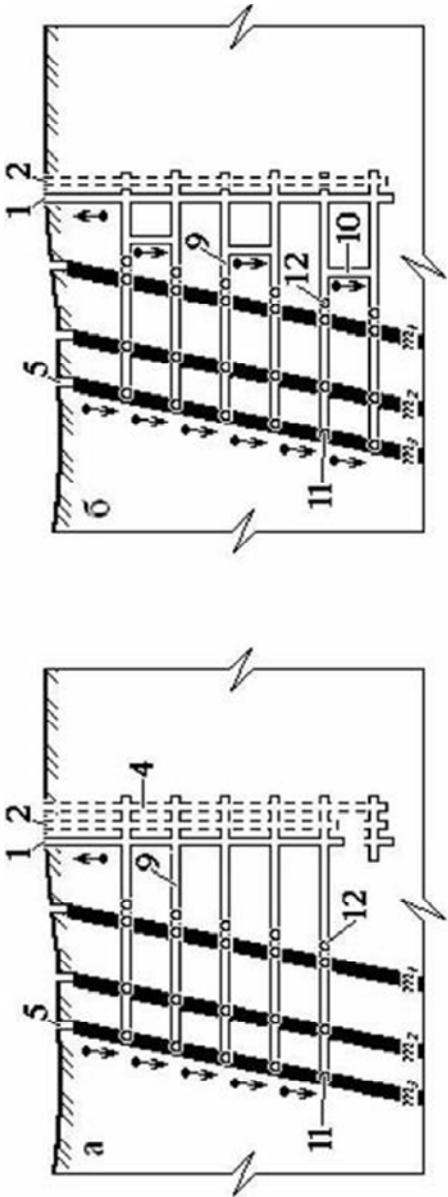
Вскрытие вертикальными стволами с этажными квершлагами
